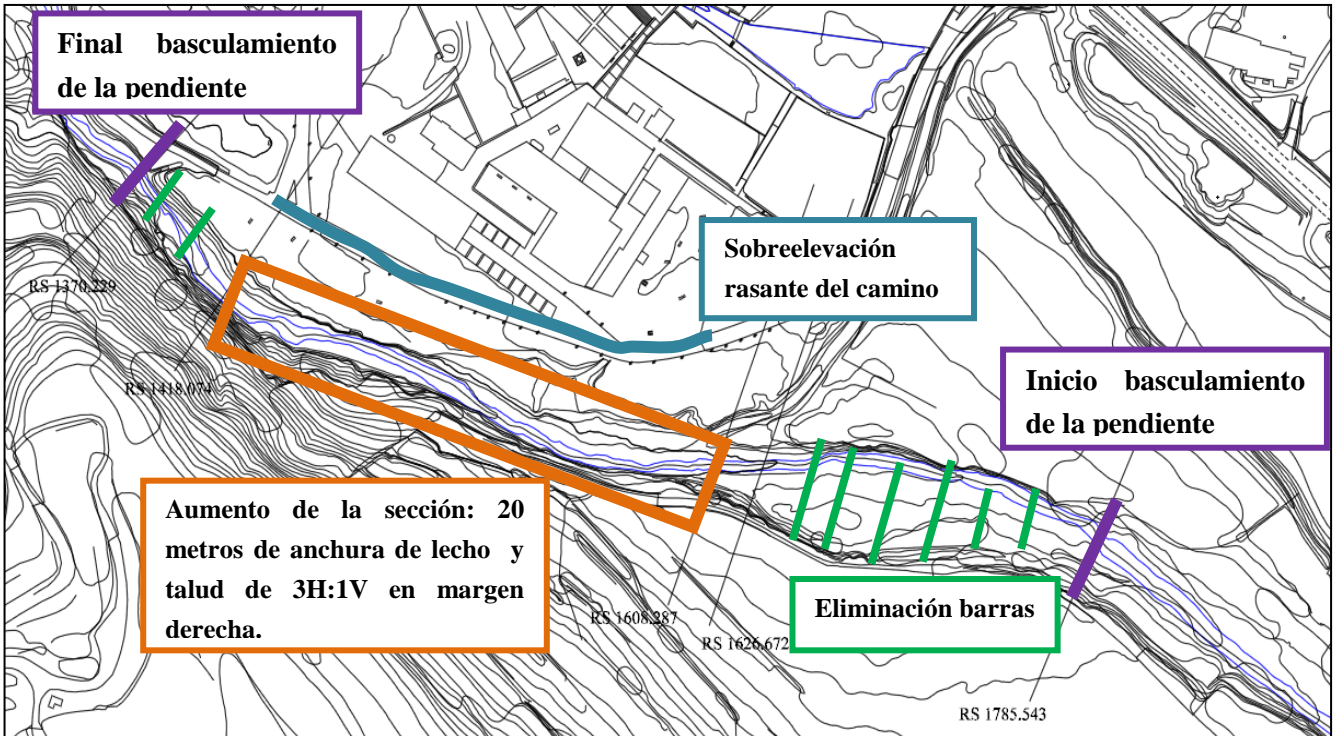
Esquema en planta de las actuaciones para la alternativa 3
